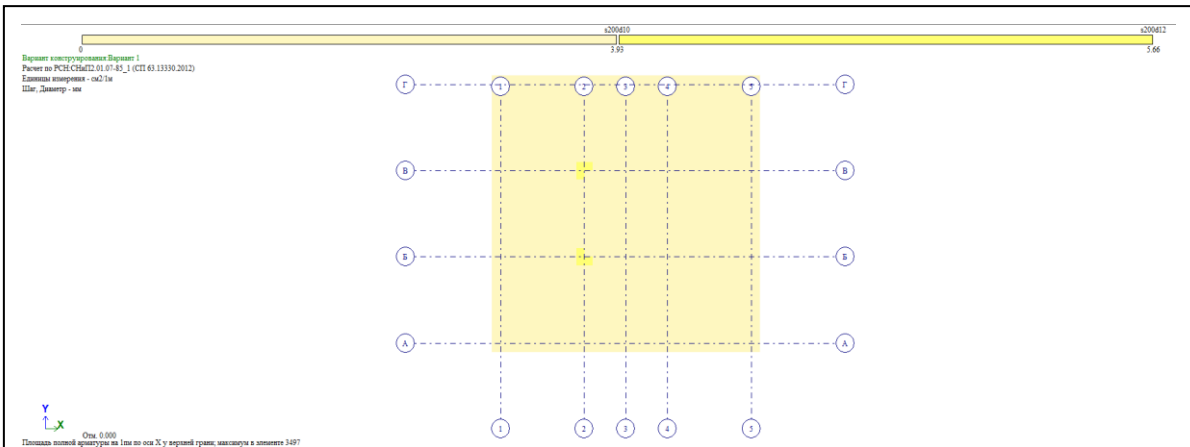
Требуемое армирование в верхней зоне плиты фундамента вдоль буквенных осей здания
